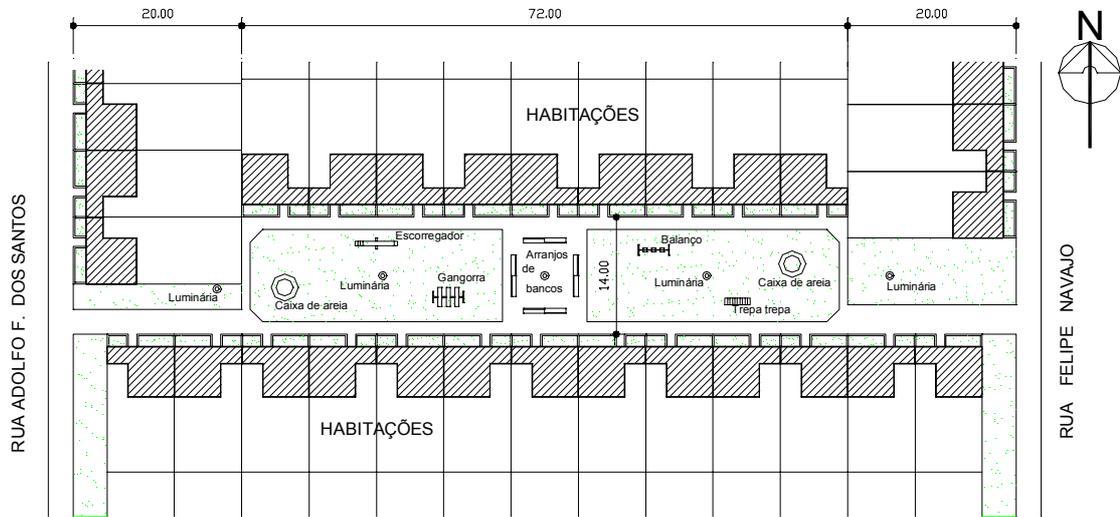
Planta Original do Espaço Aberto Comum 6 do CHST
